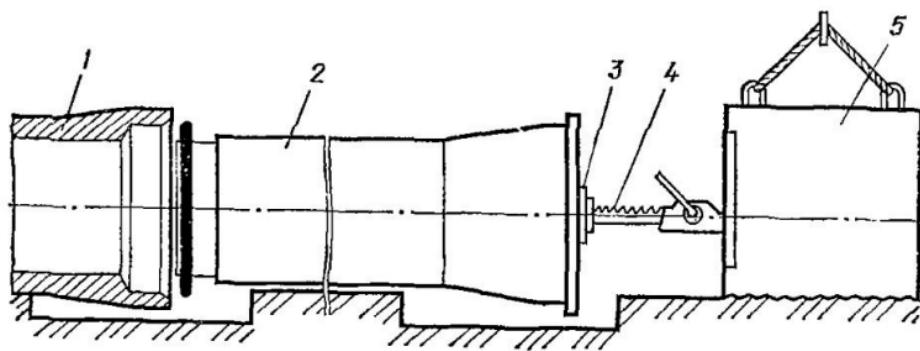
Монтаж труб с помощью реечного домкрата и бетонного упора
